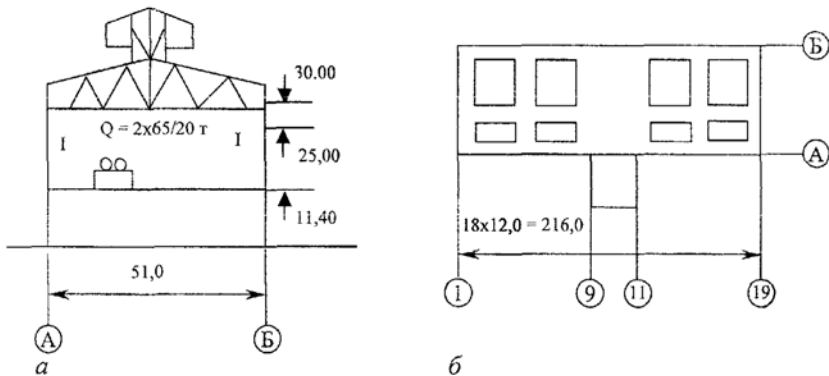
Главный корпус Ростовской ТЭЦ-2: а – разрез ГК; б – план ГК
